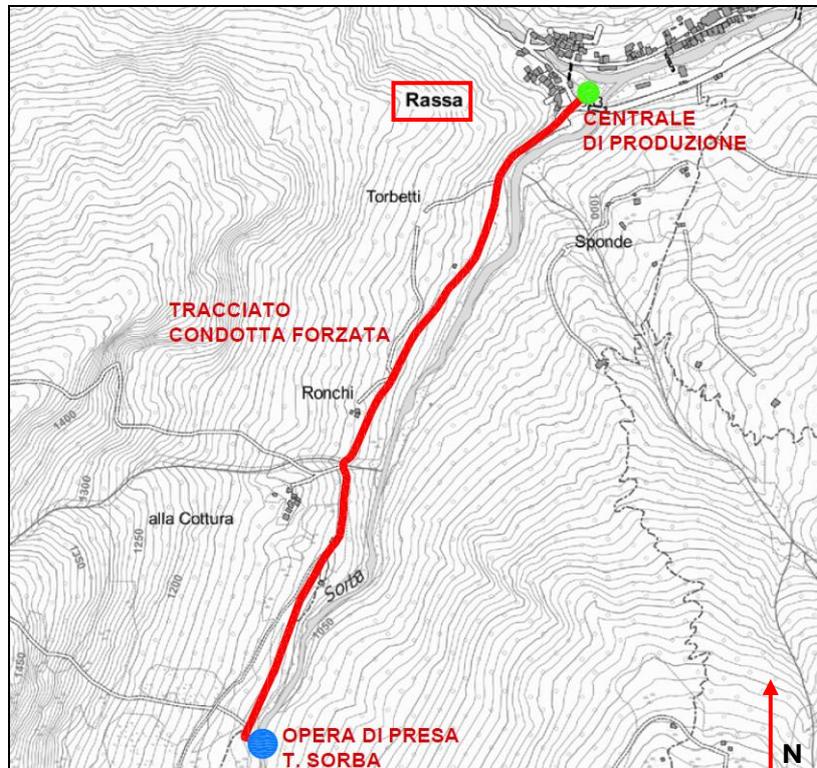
Estratto planimetrico progetto idraulico: indicazione componenti
